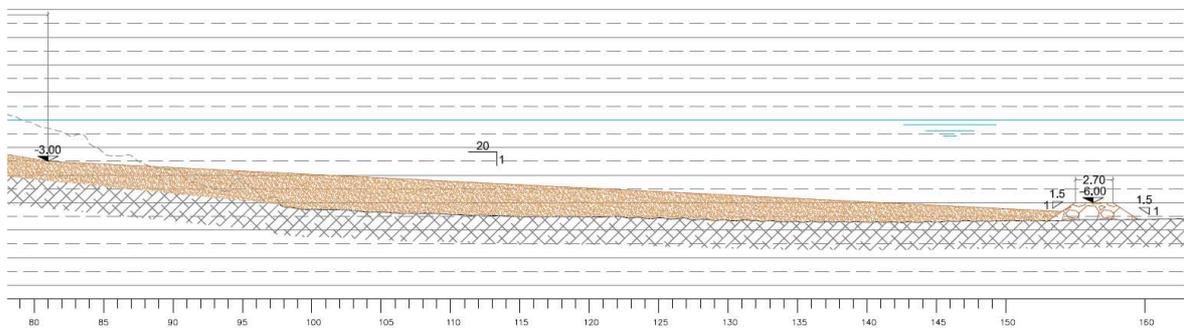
sezione tipologica del ripascimento - lato mare (sezione 13)
